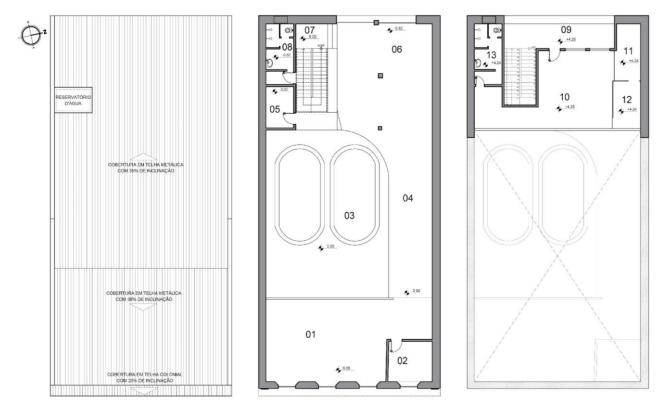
Levantamento Arquitetônico - Cobertura e Plantas Baixas.
